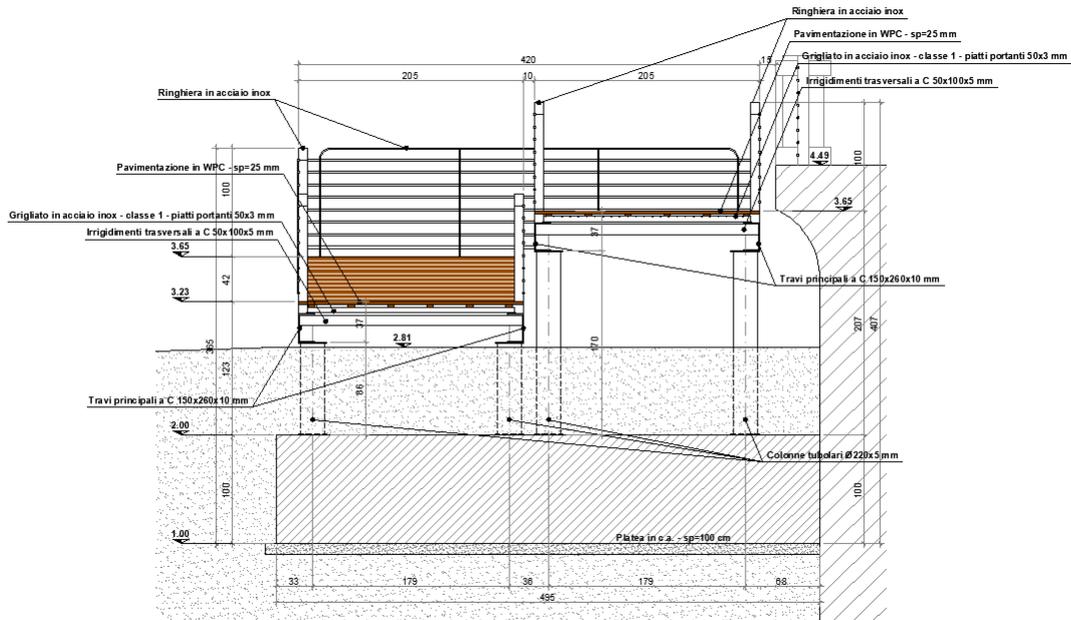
Sezione trasversale tipo blocco rampe di accesso alla spiaggia
